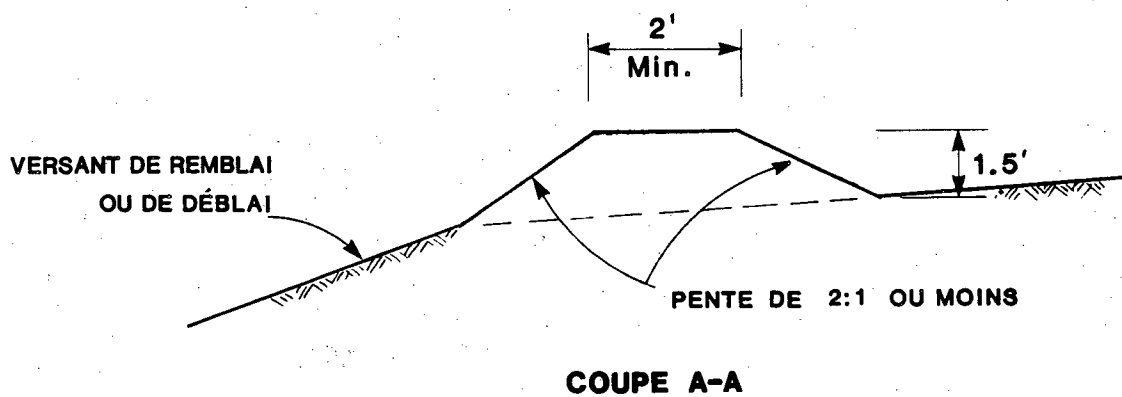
COUPE TRANSVERSALE D'UN REMBLAI DE DÉRIVATION
